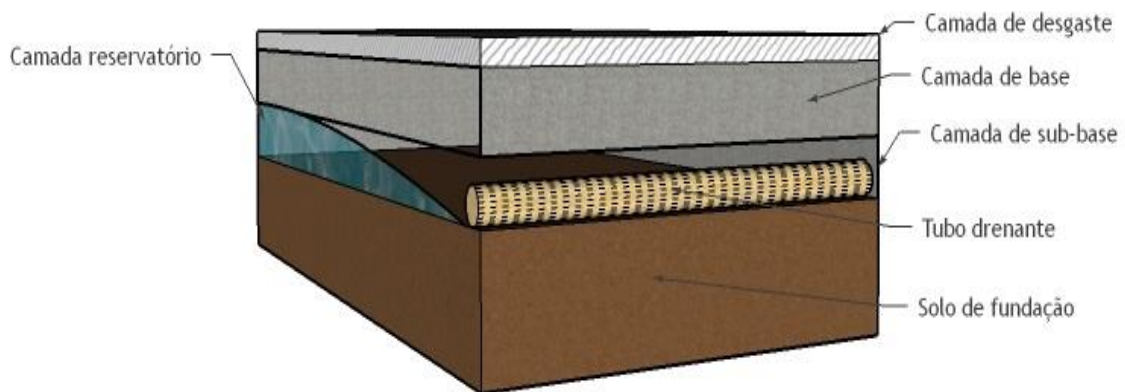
Modelo da estrutura de um pavimento permeável (adaptado Trandem,2016)
